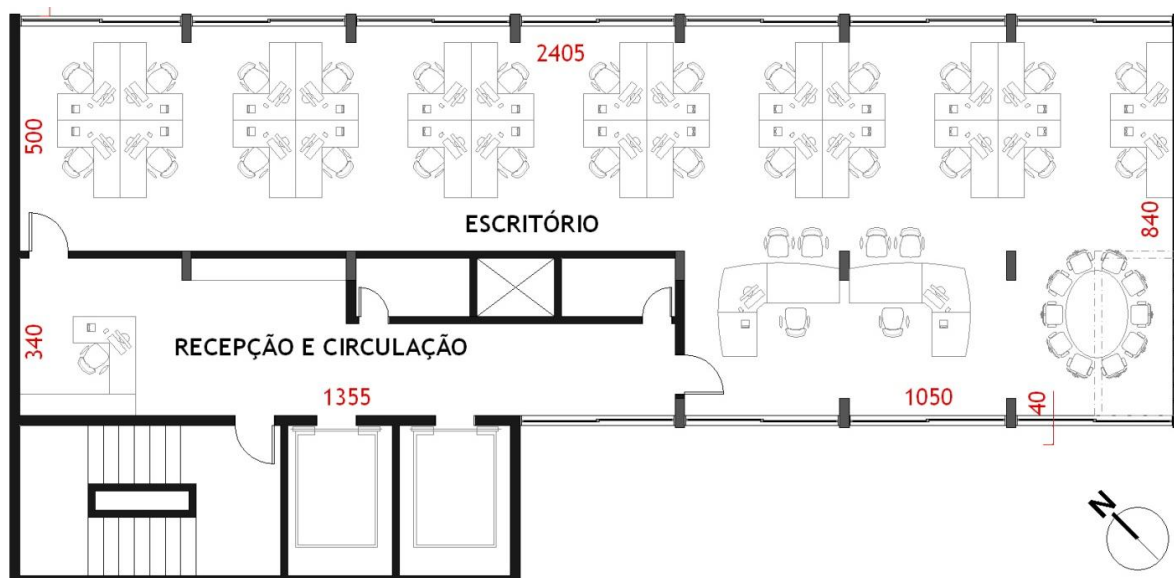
Planta do pavimento tipo – proposta de layout.
